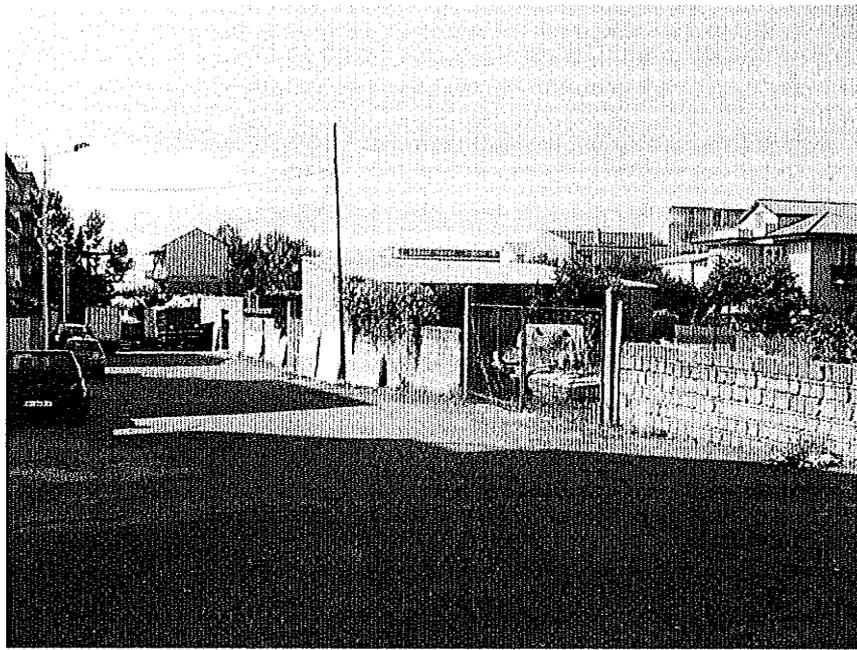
Prospetto frontale su cortile interno Fabbricato B
